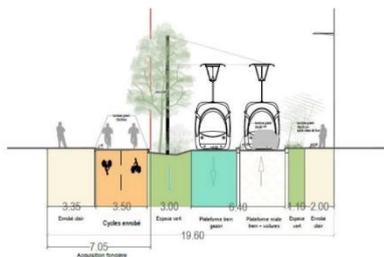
COUPE PROJET AU DROIT DE LA RUE CHARLES PLASSE
